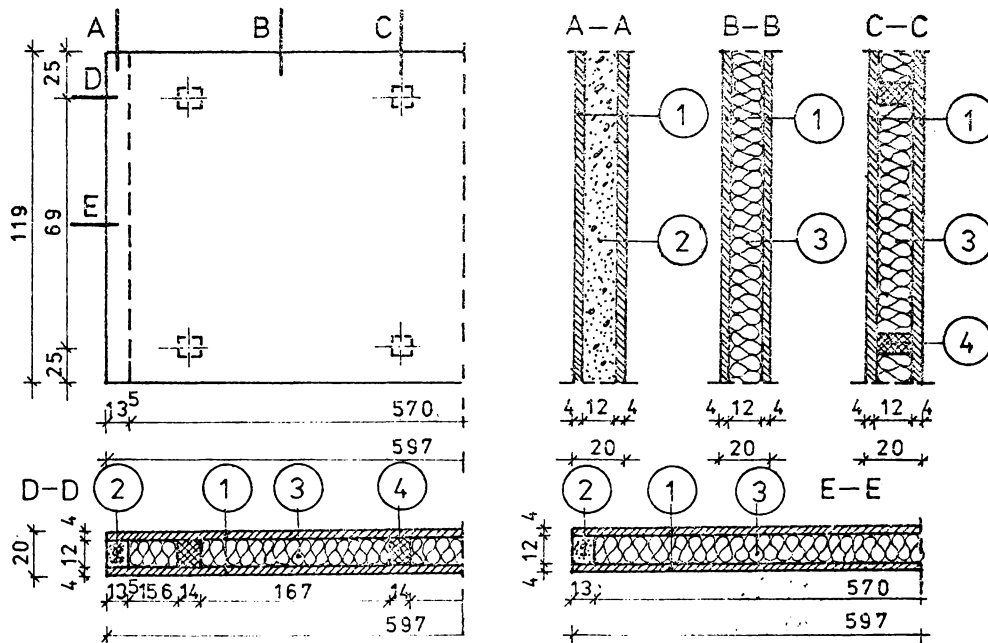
PANOU PREFABRICAT DIN BETON ARMAT (IASI)
